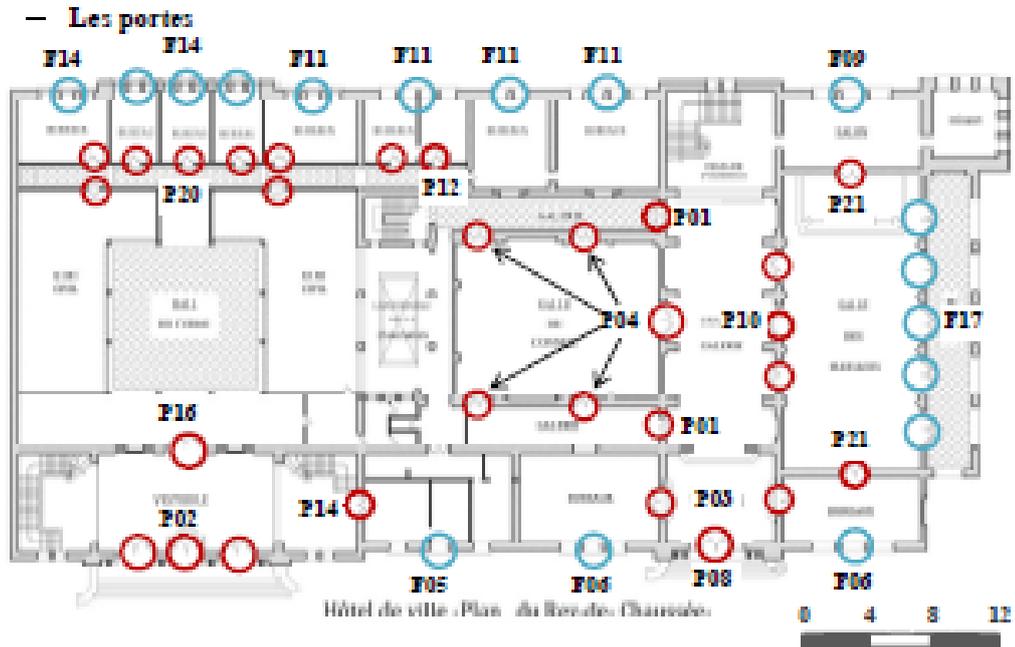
Plan de repérage des portes et fenêtres du Rez-de-chaussée, hôtel de ville de Skikda .
